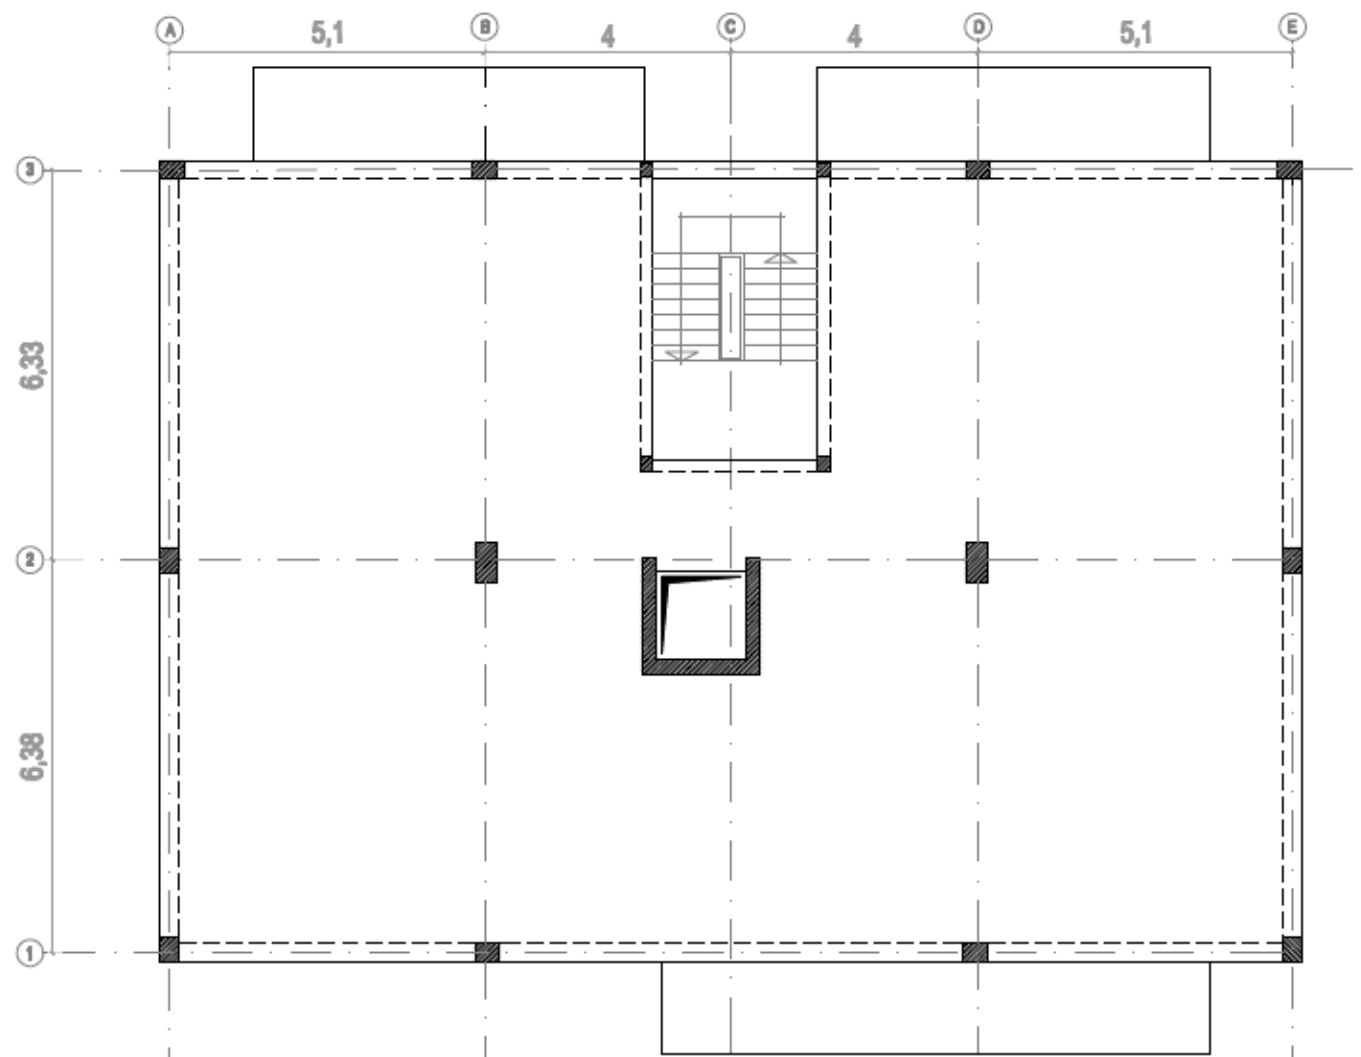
Planta estrutural do piso 1, 2 e 3
